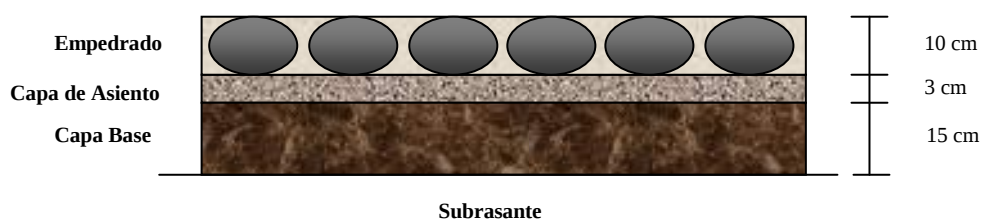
Diseño adecuado del empedrado Fuente: Elaboración Propia
